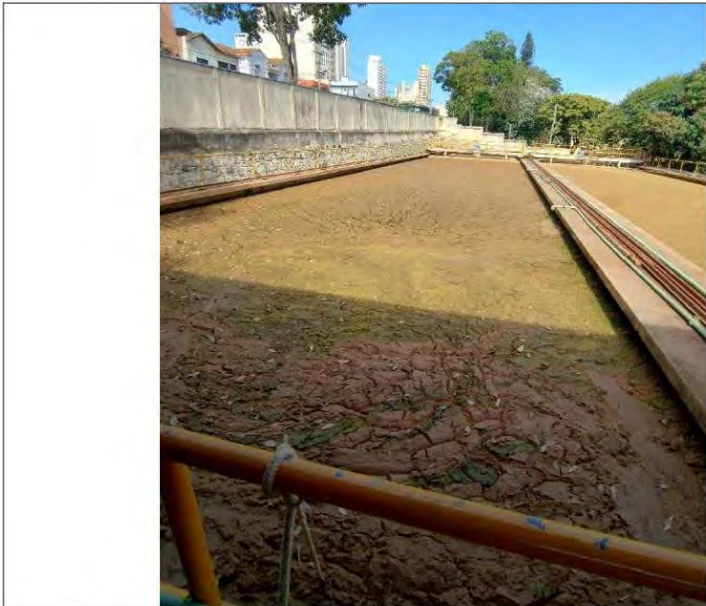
Vista do Decantador 1, com material sobrenadante enrijecido (03/Ago/2024).
